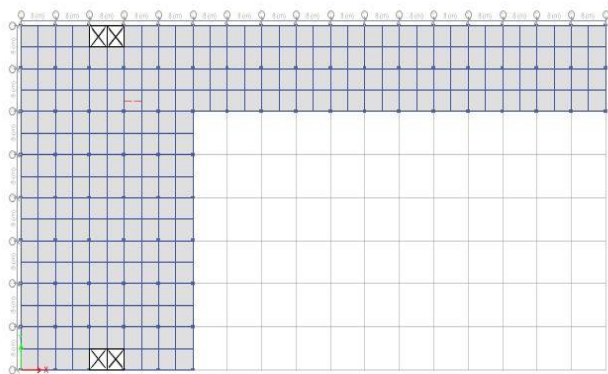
Denah Lantai 7 - Lantai 8 Model B1
